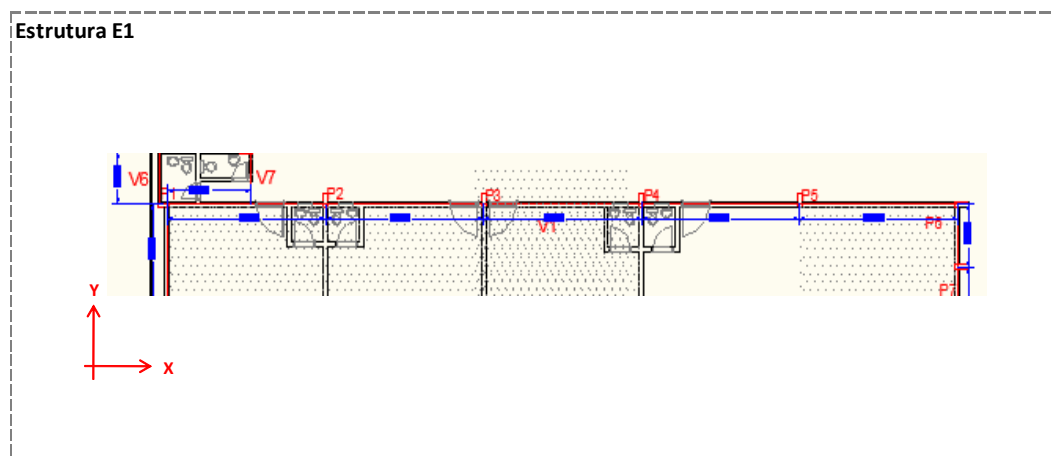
Vista em planta da estrutura 1, pórtico da viga 1 (P1 ao P6)
